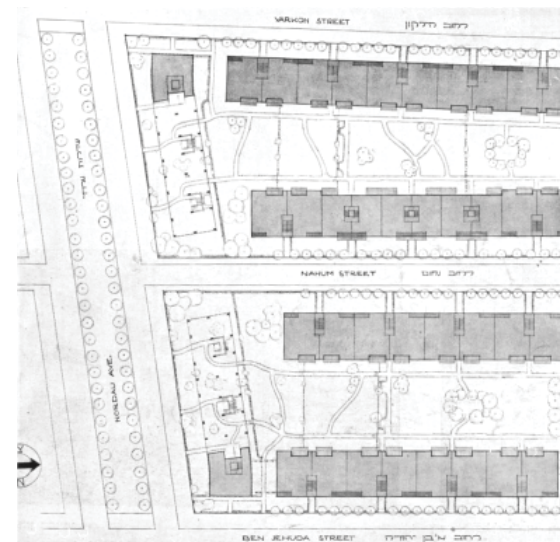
Arie Sharon. Planta implantación viviendas para obreros A, B, C. 1931.
